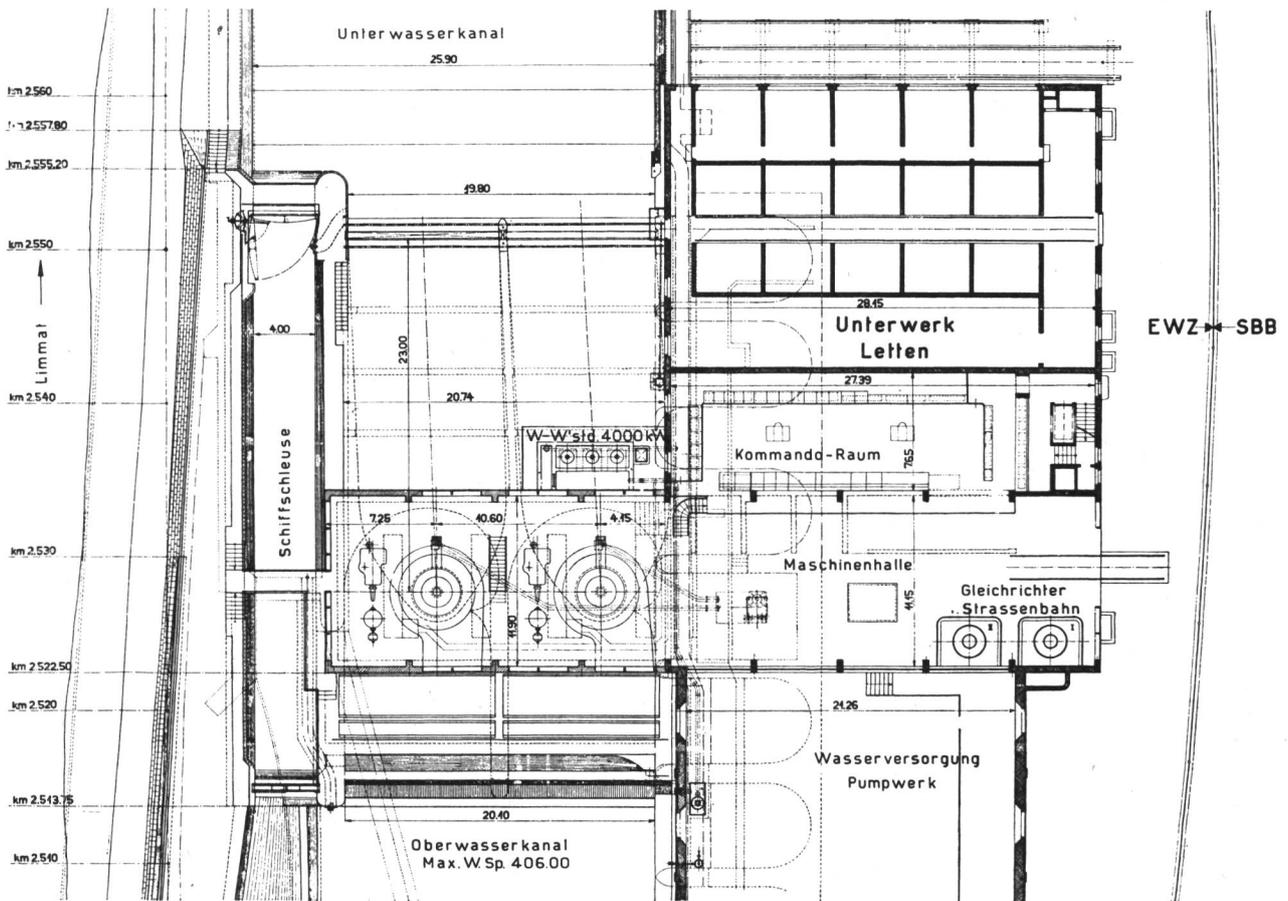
Limmatwerk Letten, Umbauprojekt 1938. Maschinenhaus, Grundriss. Maßstab 1 : 500.
